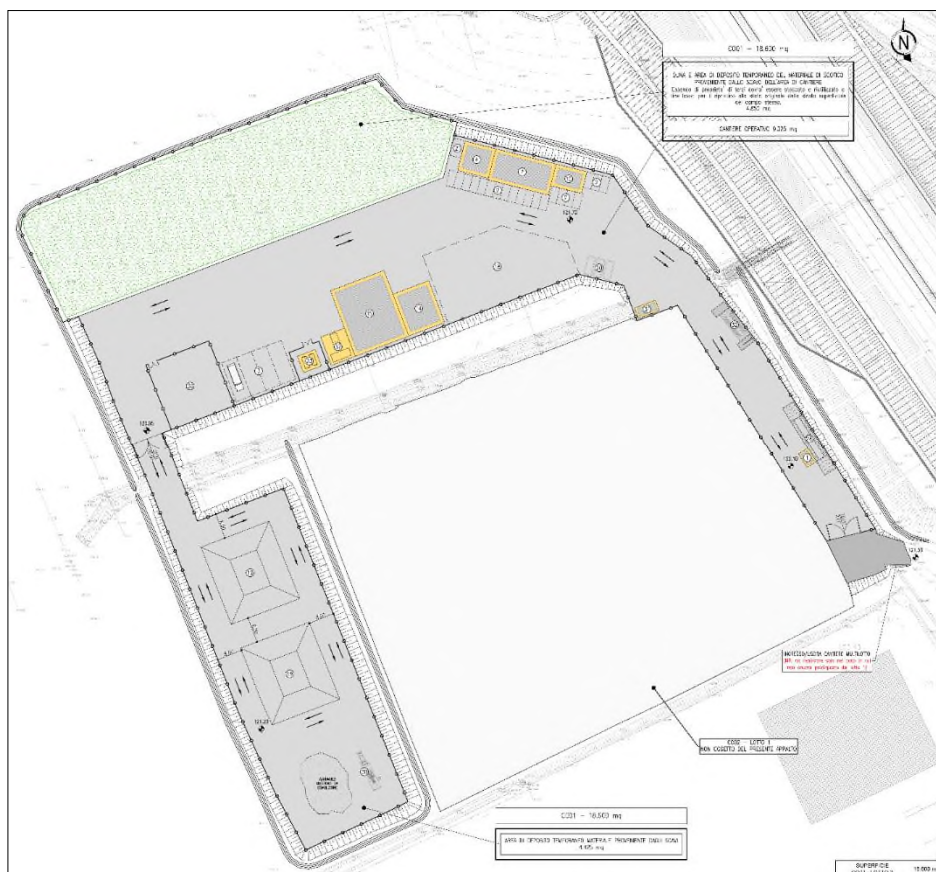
Planimetria generale del cantiere CO-01, Lotto 2
